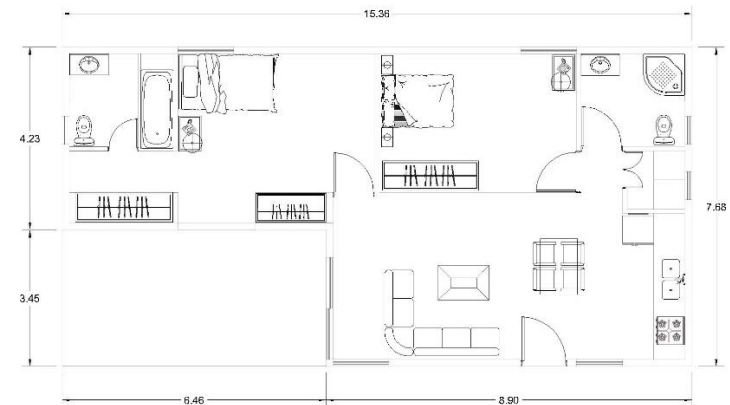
Planta de distribución arquitectónica 95.67 m^2 + 22.28 m^2 de porche, con dimensiones generales de 15.36 m. de longitud por 7.68 m de ancho y un total de 117.95 m^2 de construcción (HOME 3, 2016).
